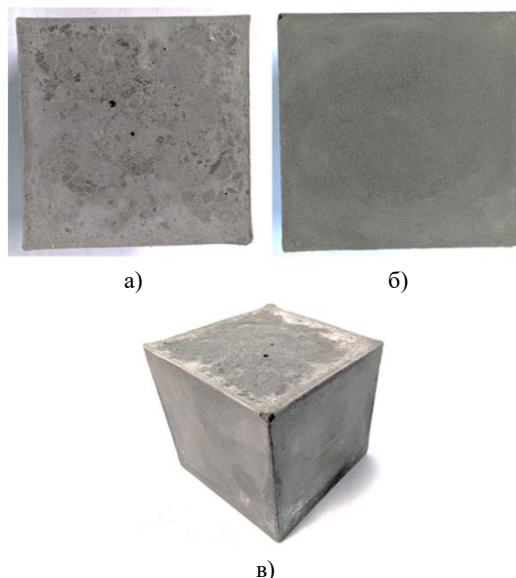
Внешний вид отвержденного образца ЦМ через 2 суток: а) верхняя поверхность; б) нижняя поверхность; в) внешний вид
